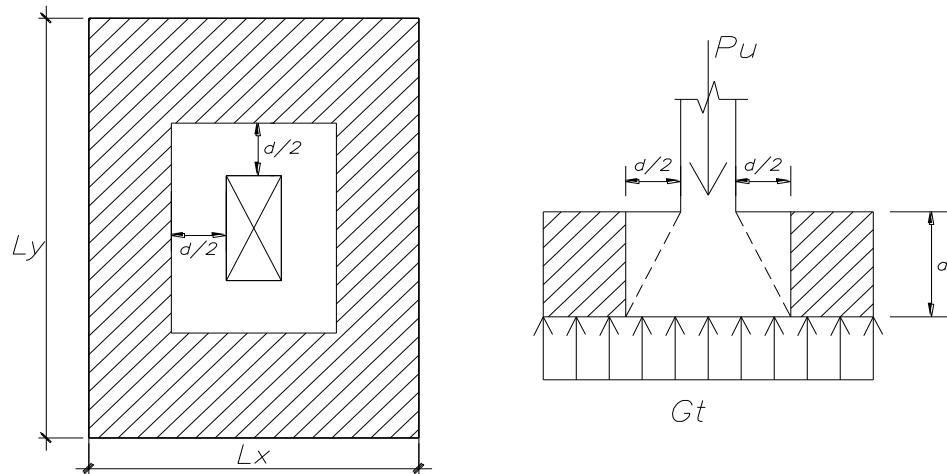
zapata Aislada con efecto de punzonamiento del concreto
